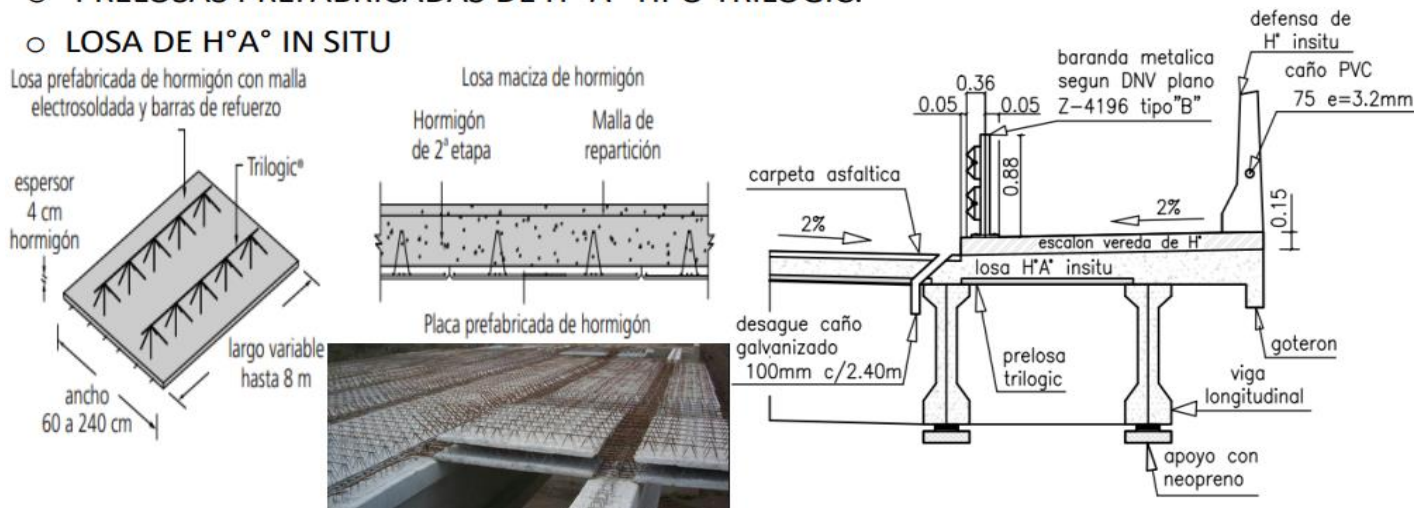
Detalle constructivo de Prelosas tipo trilógic y losa de hormigón Insitu de puente Lago San Roque.
